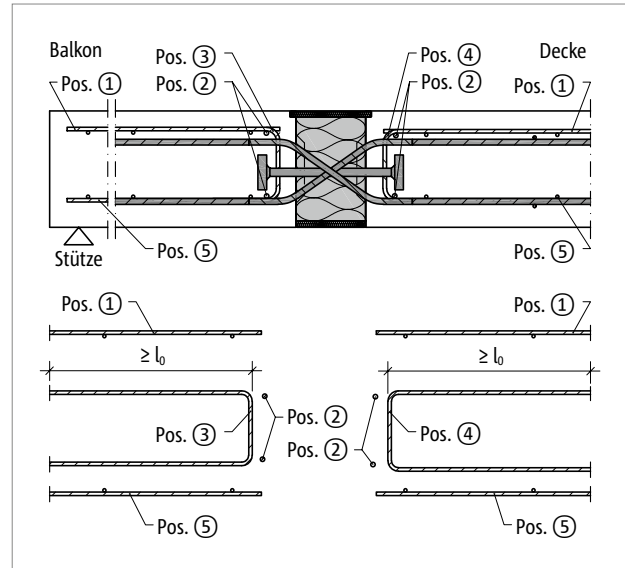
Schöck Isokorb® XT Typ QP-VV: Bauseitige Bewehrung
